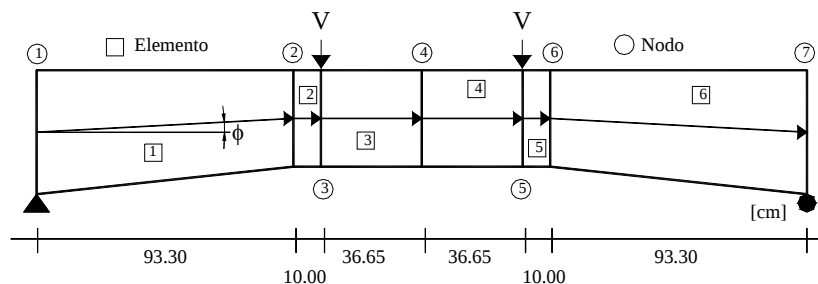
Modelo utilizado para el análisis de las TACR con elementos viga-columna
